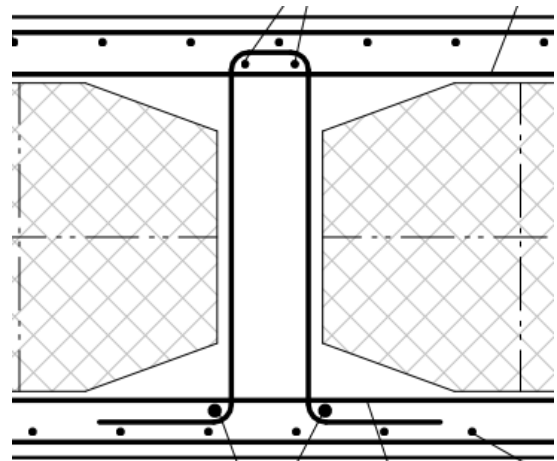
Armado de forjado aligerado. Armadura de atado de los aligeramientos
